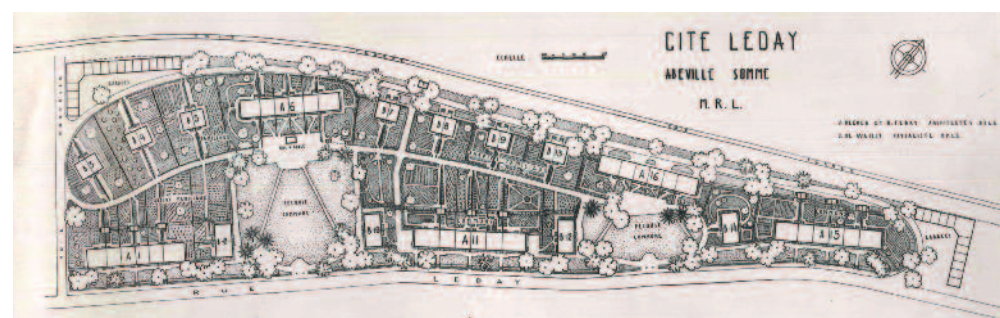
Cité Leday, plan masse, tirage, par Jean Decock, R. Ferry et Jacques de Wailly, [1947] | Arch. mun. Abbeville, fonds Jacques de Wailly, [non coté] ©Ville d'Abbeville.
